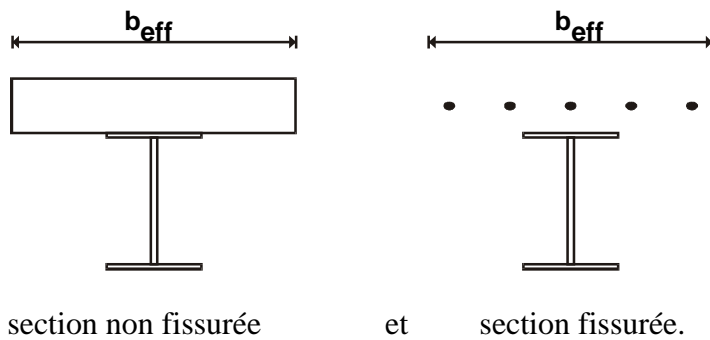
Hypothèses sur la fissuration des sections pour le calcul de l'inertie des sections mixtes
